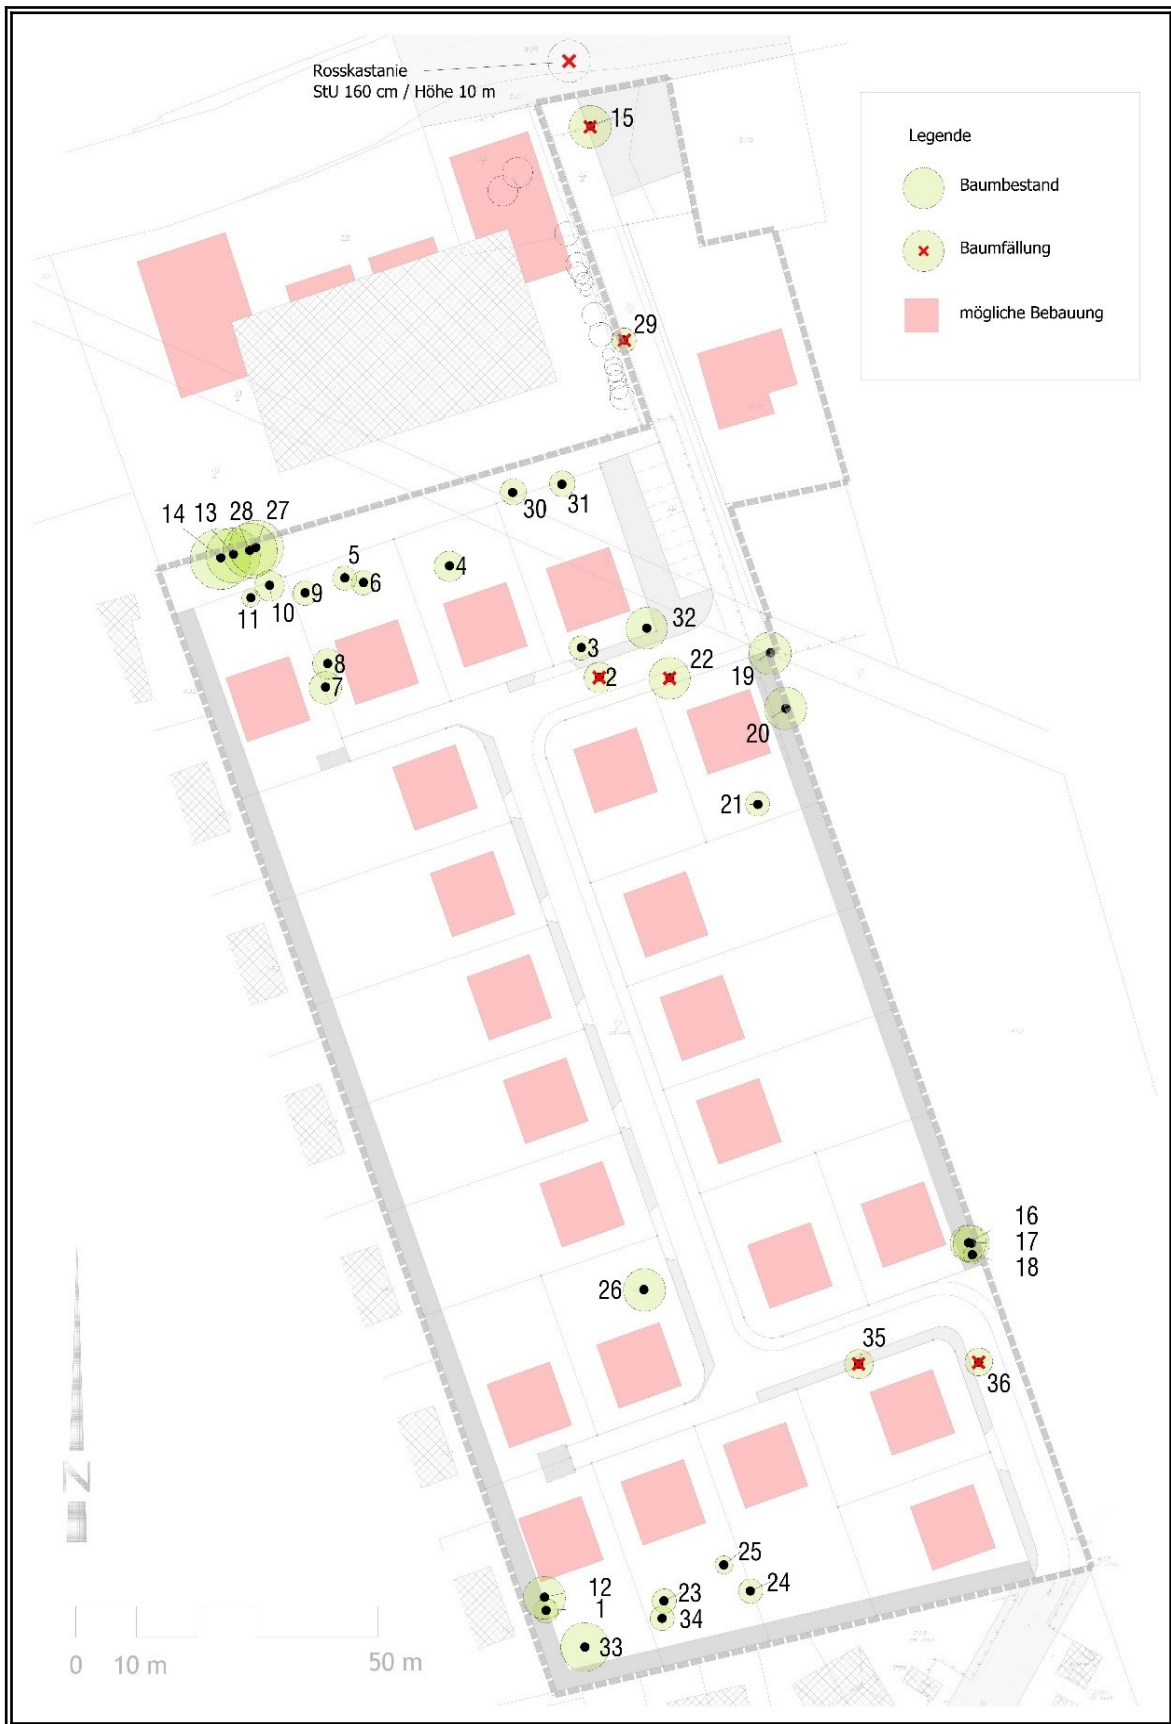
Baumbestand und unvermeidbare Baumfällungen⁵³
